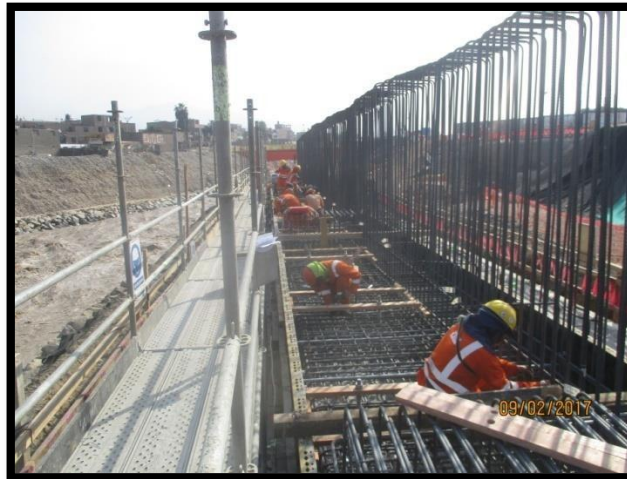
Colocación de pernos de anclaje para plancha metálica.
